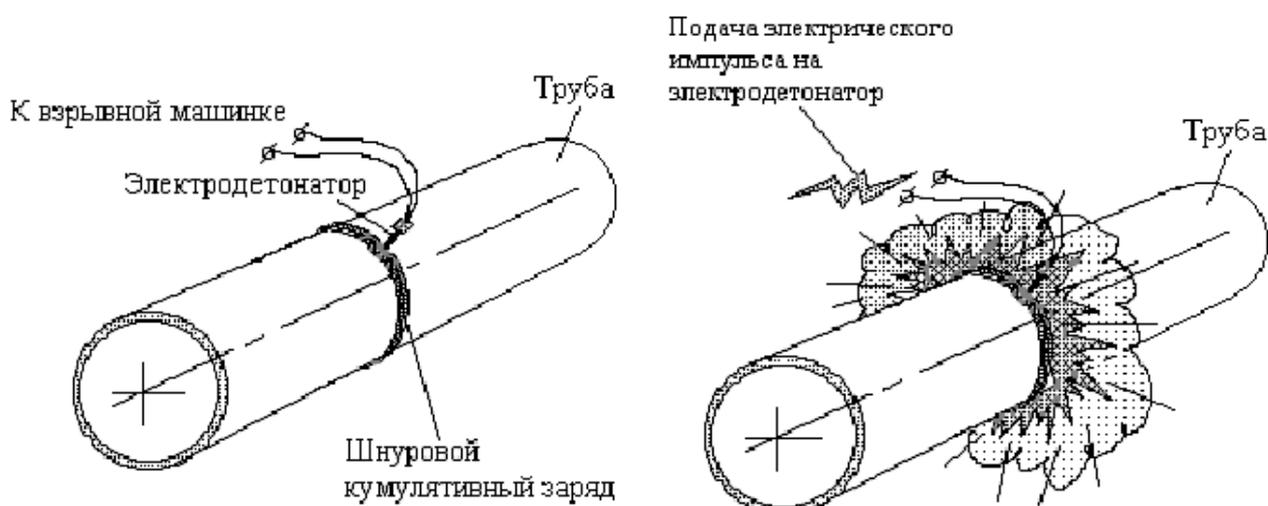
Установка и подрыв эластичного кольцевого отрезного заряда типа ШКЗ
